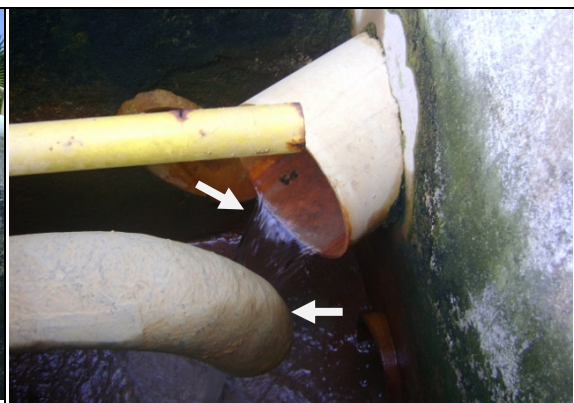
Filtragem de Pressão: Vazamento nos registros de descarga.
